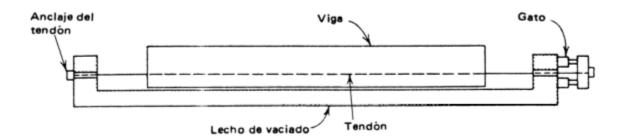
(j)Sistema de pretensado www.ingenieriacivil.cjb.net
